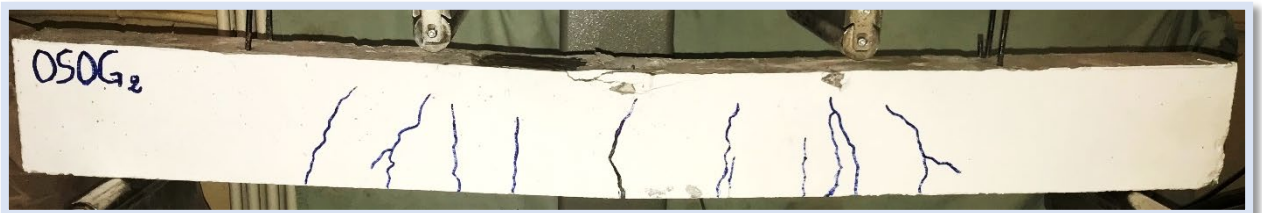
Schémas de fissuration de la poutre témoin 2 (BT2S0G0).
